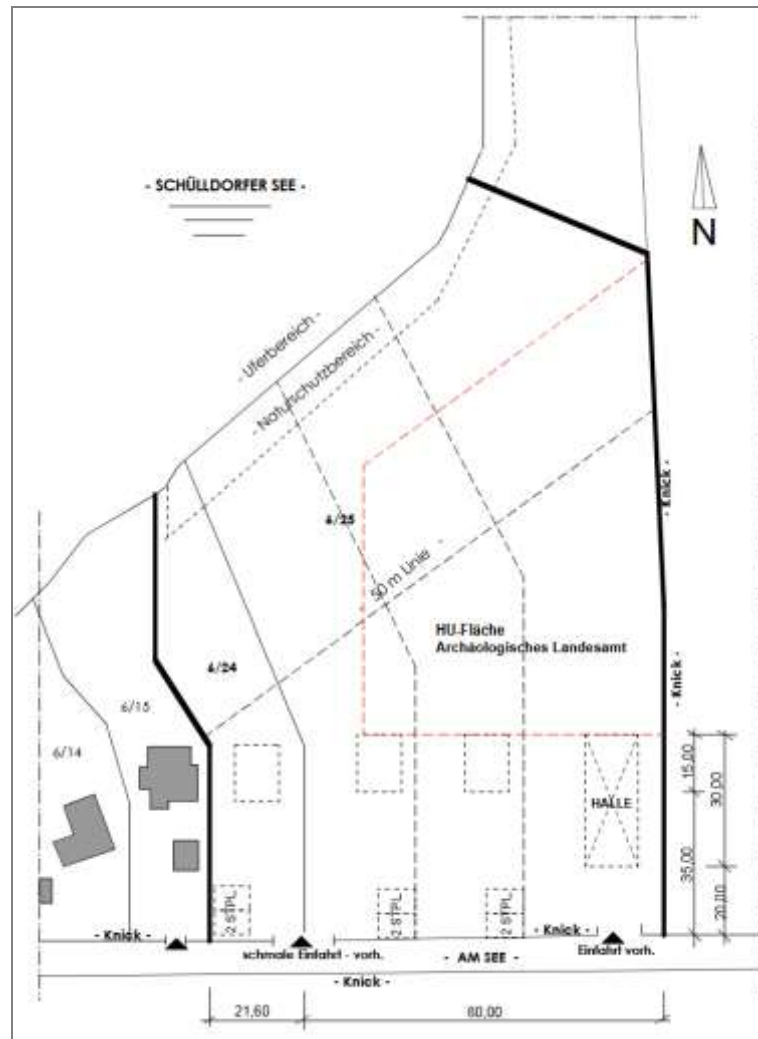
Hauptuntersuchungsfläche des Archäologischen Landesamt im Plangebiet, Planstand 22.10.2025 (KÜHL 2025, genordet, ohne Maßstab)
